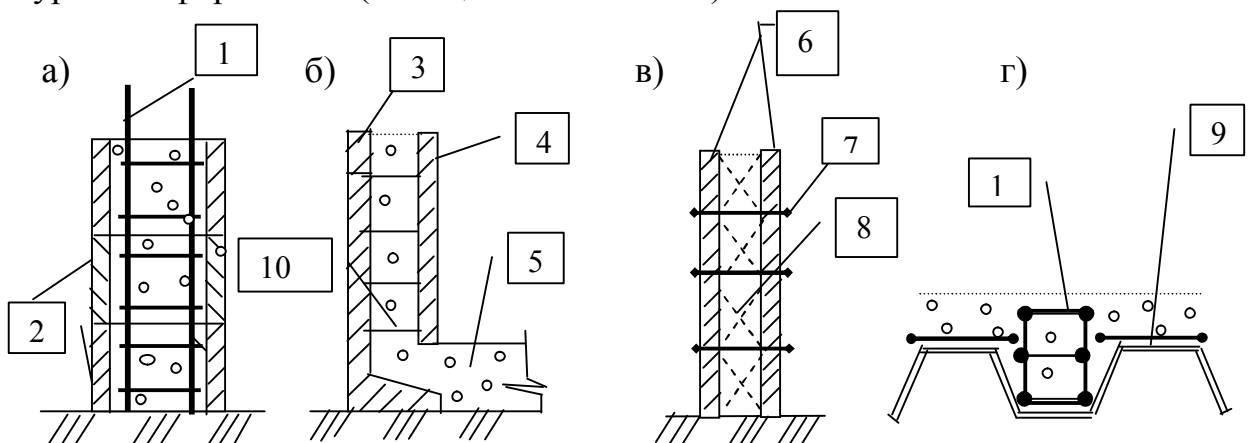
Конструктивные схемы несъёмных опалубок:
